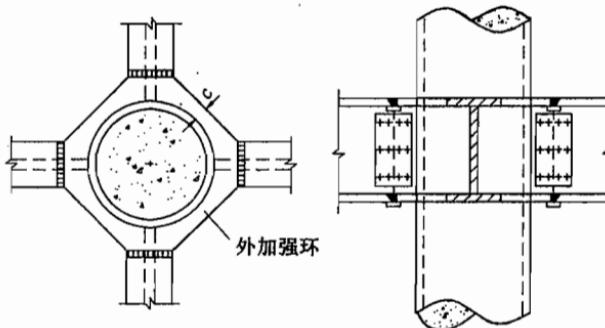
钢梁与钢管混凝土柱采用外加强环连接构造示意
